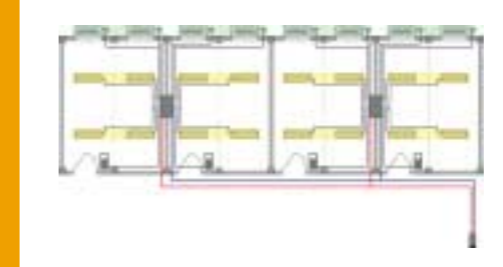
Achsenorientierte Installation mit Binäreingängen (ursprüngliche Planung)
